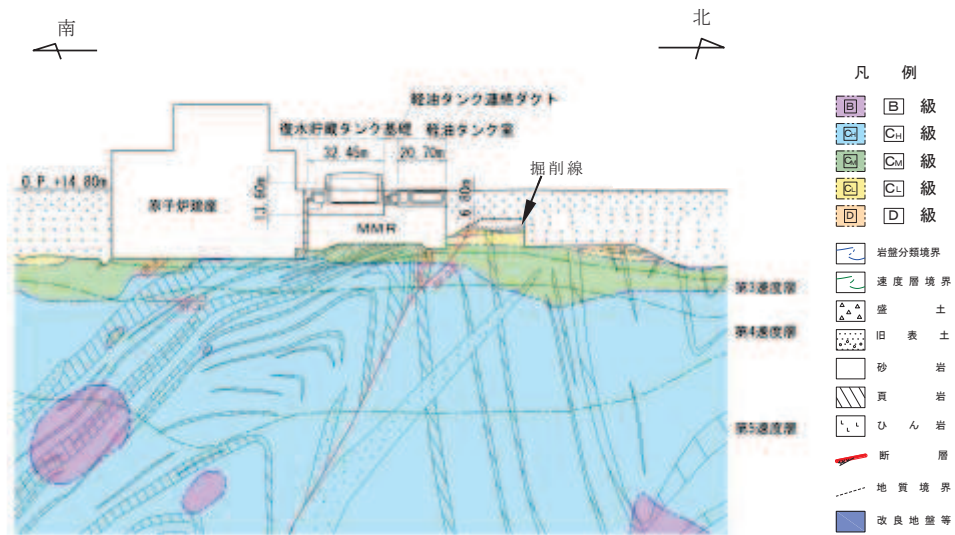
軽油タンク室，復水貯蔵タンク基礎の地質断面図 (⑮-⑮断面)
